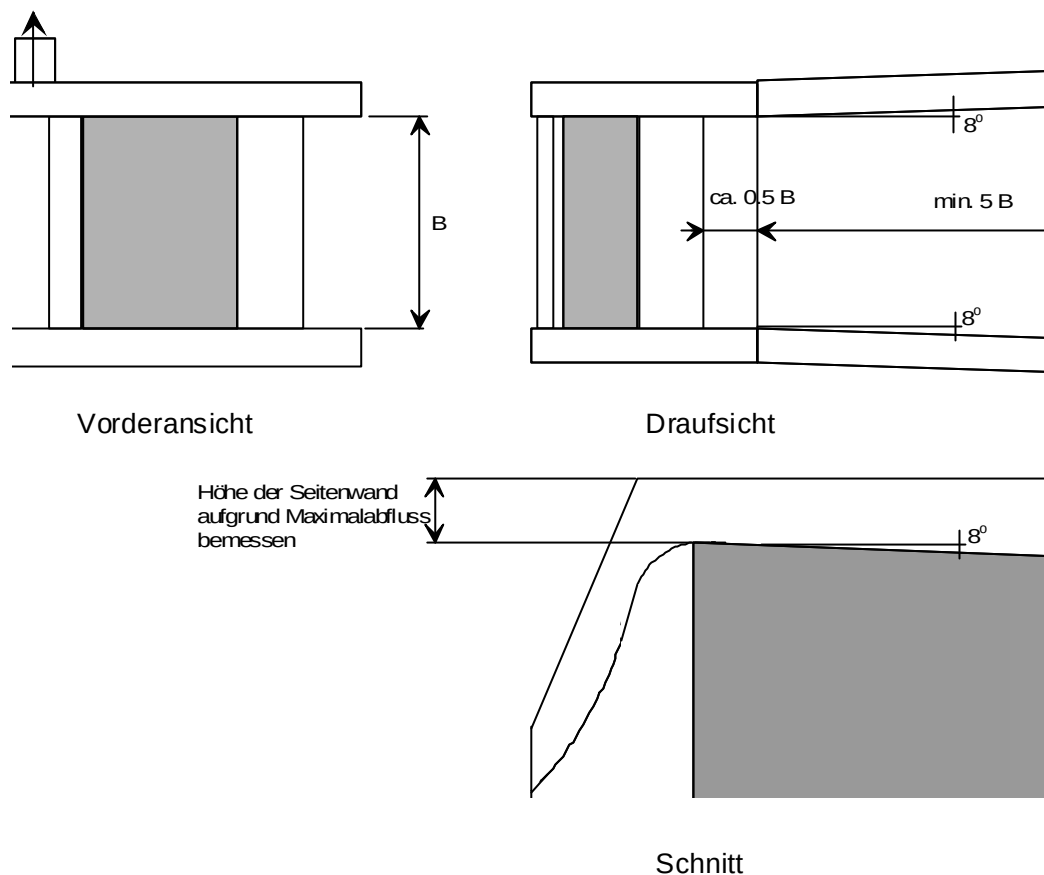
Einlaufstrecke für gleichmässige Rechenanströmung
